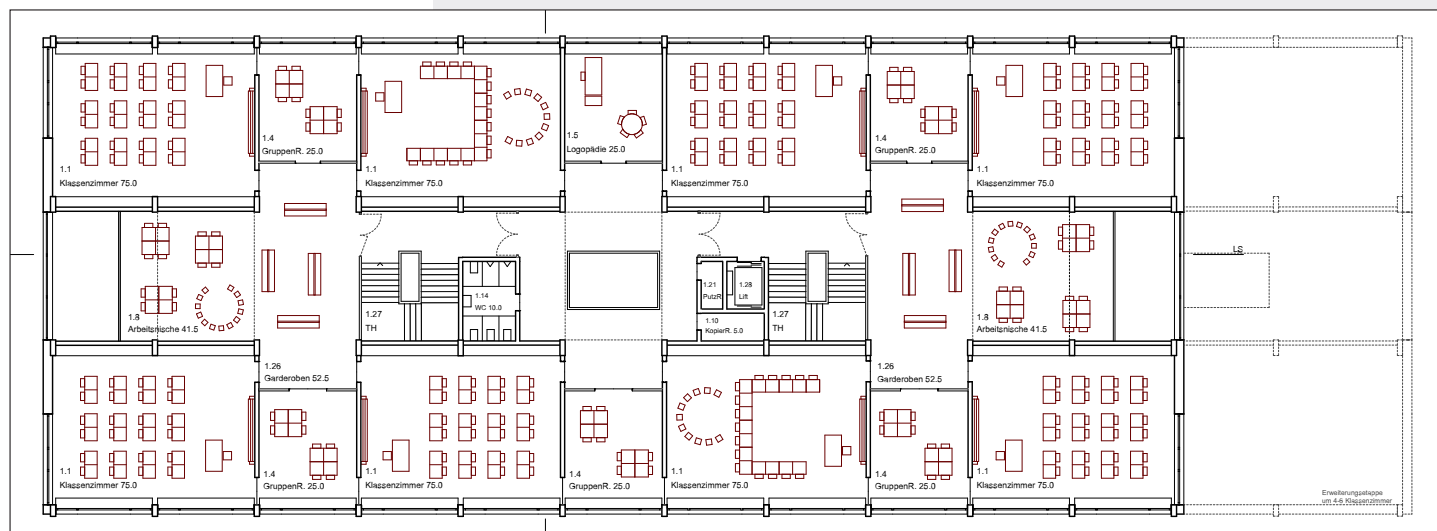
Grundriss 3. Obergeschoss (Regelgeschoss)
